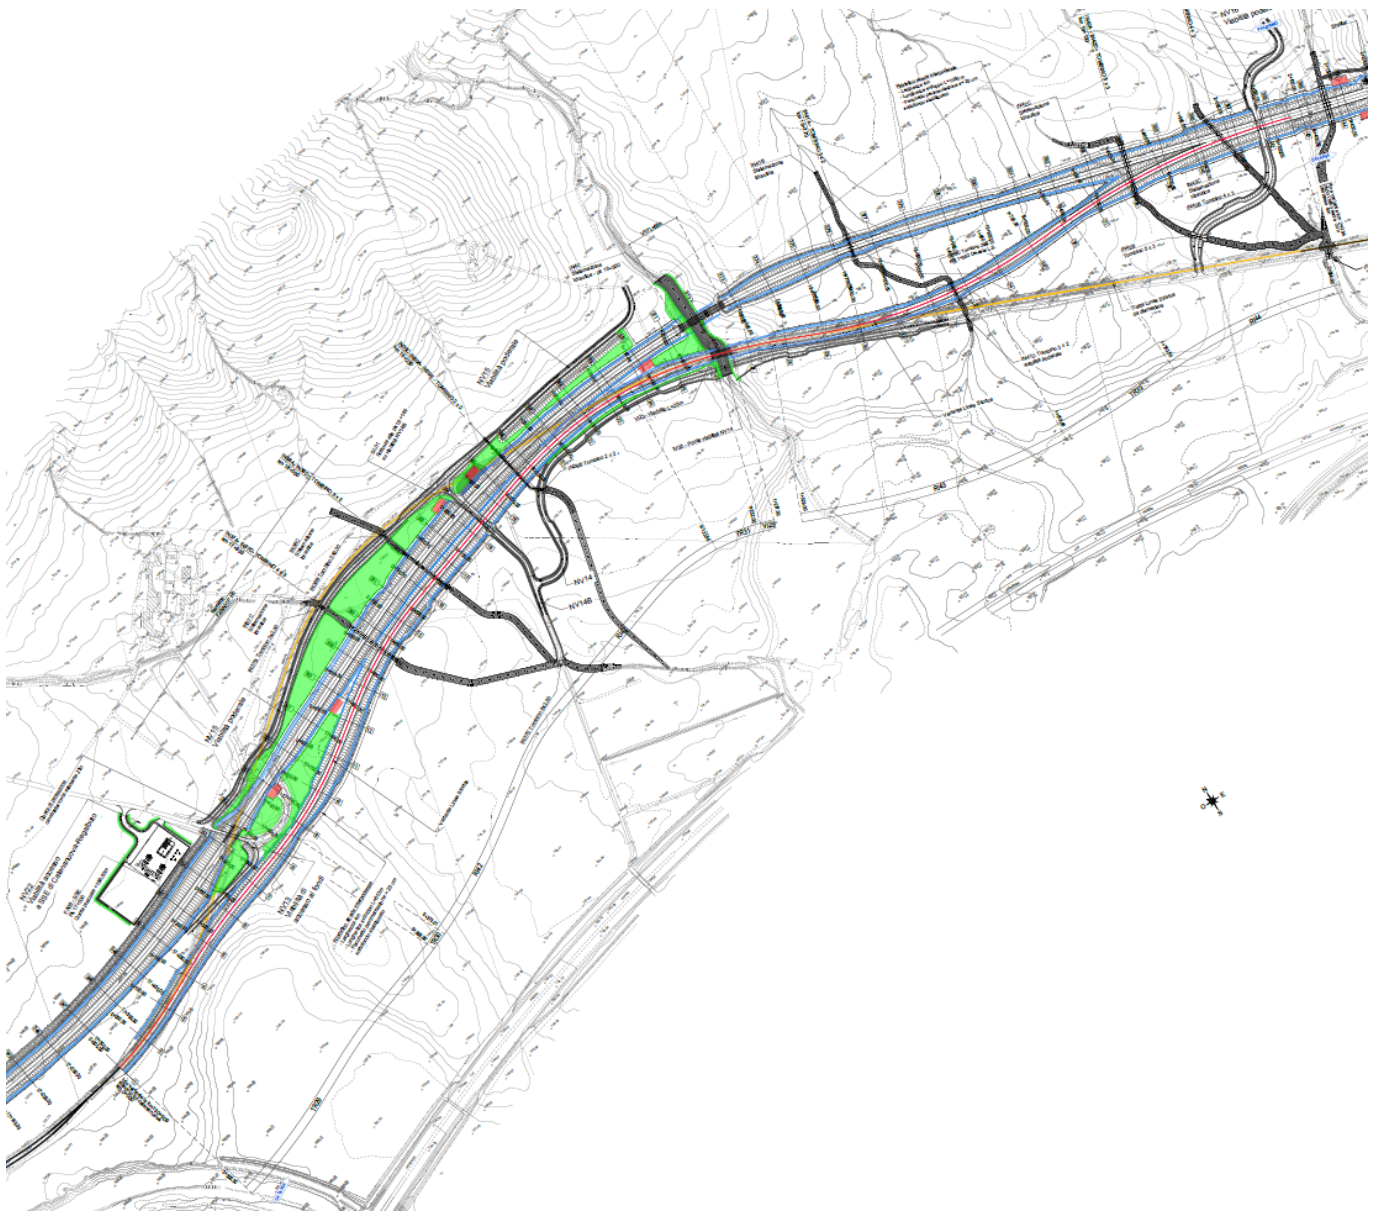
Stralcio planimetrico Variante Definitiva alla Linea Storica al km 190+909
